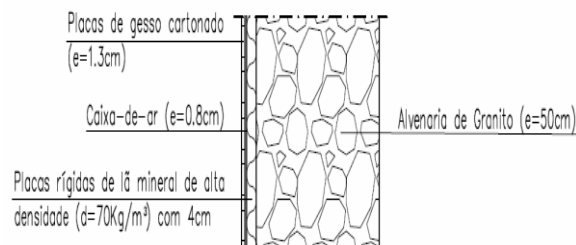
Pormenor construtivo da Parede de meação - Pi2
